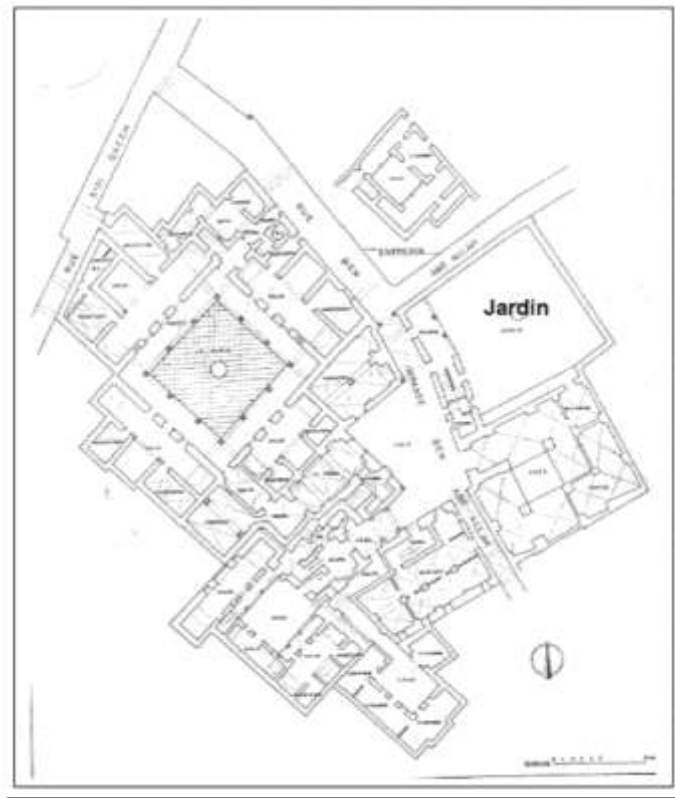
Plan d'une riche demeure tunisoise (Dar ben Abdallah), rez-de-chaussée et étage (XVIIIe –XIXe siècle). Source : (Binous, J. et al. 1985, p.38)
